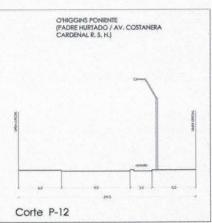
Perfil calle O'Higgins sector Sur Ribera norte situación existente y situación proyectada
